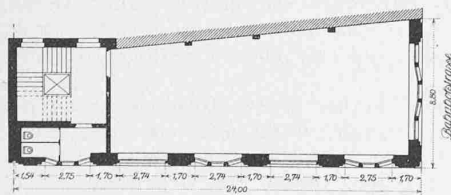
Grundriss des Kohlenhofs. 1 : 400.
